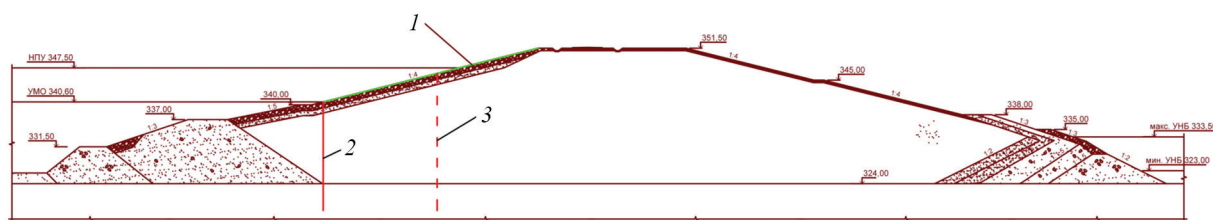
Варианты № 1 и № 2 реконструкции Кайракумской земляной плотины: 1 — стальное шпунтовое ограждение по верховому откосу плотины (вариант № 1); 2, 3 — вариант № 2
